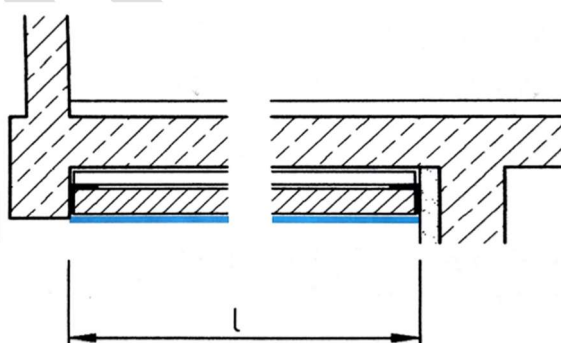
Sous-face de balcon ; coupe verticale céramique / enduit
